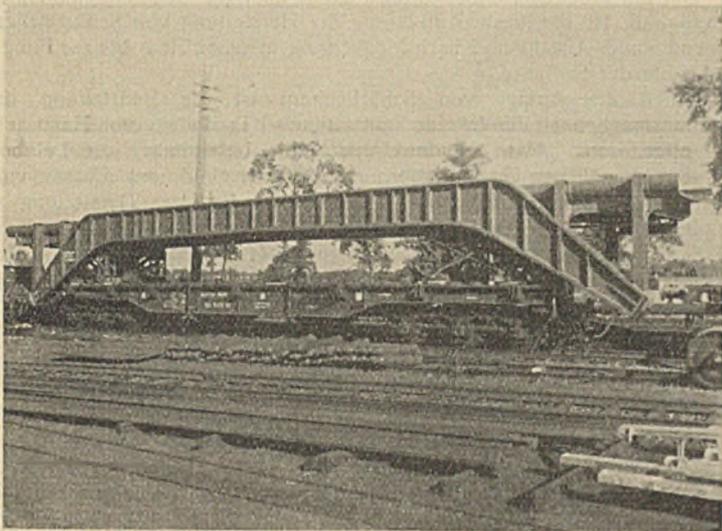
Überbau für die Unterführung der Erkrather Straße, auf Bahnwagen verladen.
